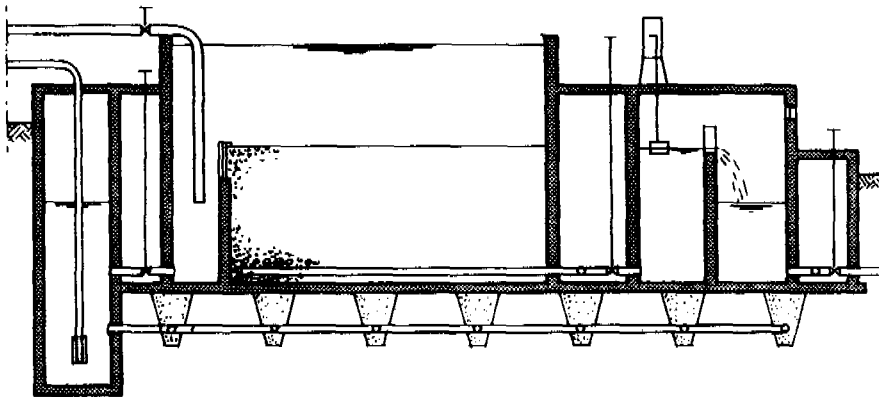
Sistema de drenaje debajo de la caja del filtro.
